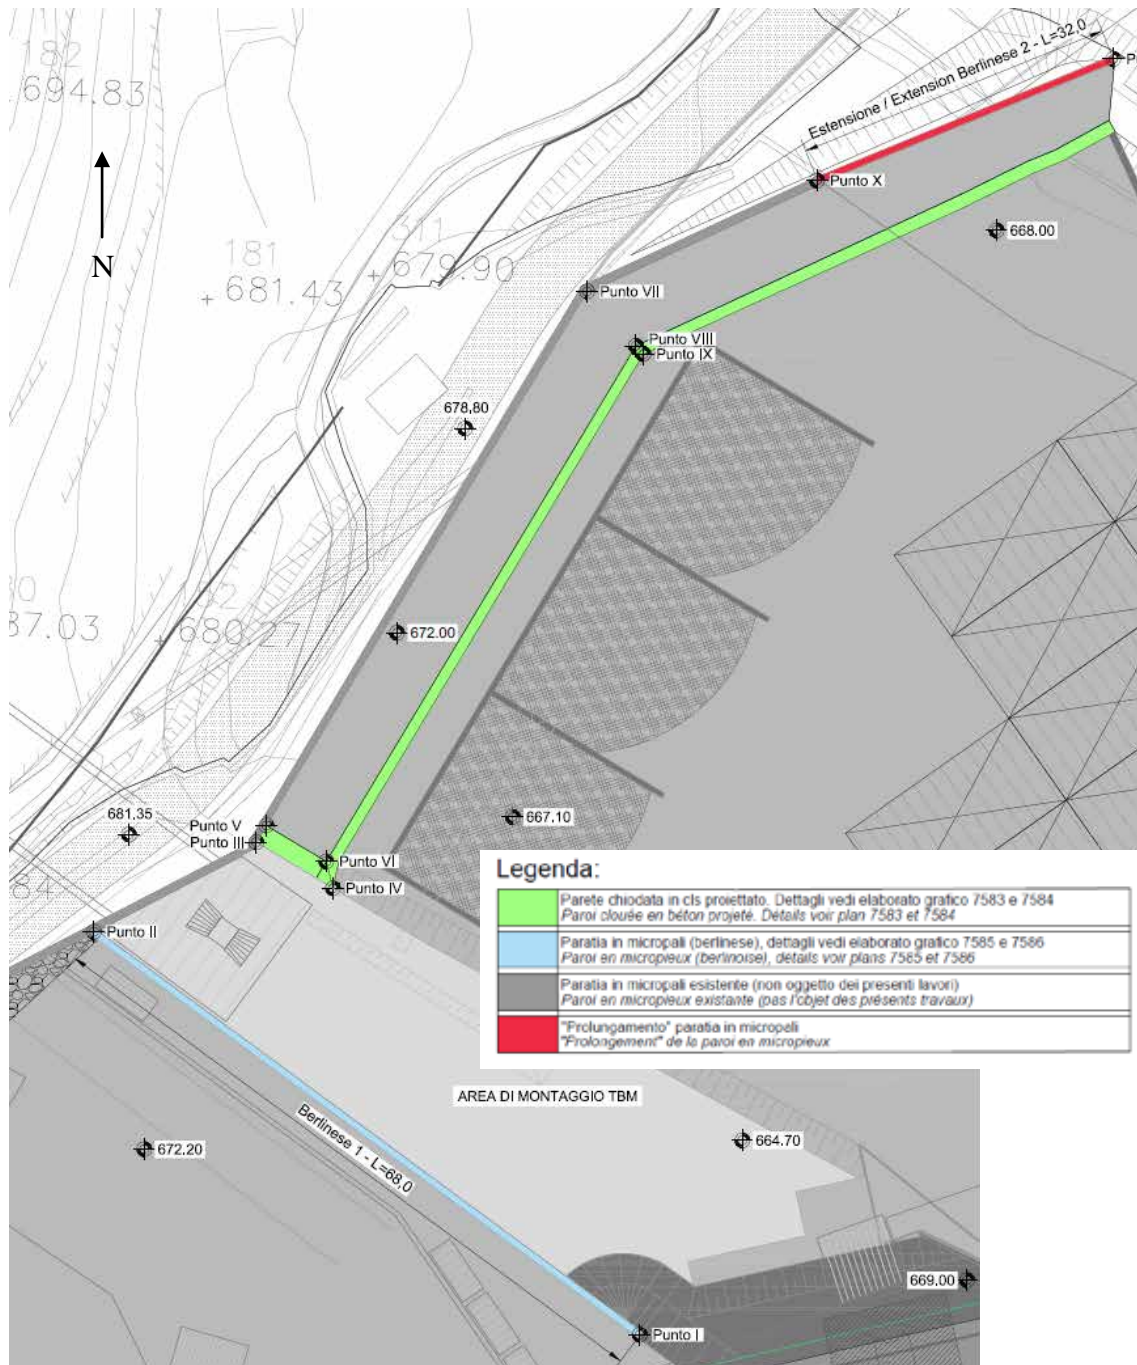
Estratto planimetria terreno del cantiere (dall'elaborato grafico n. PRV\_C3A\_7582)
